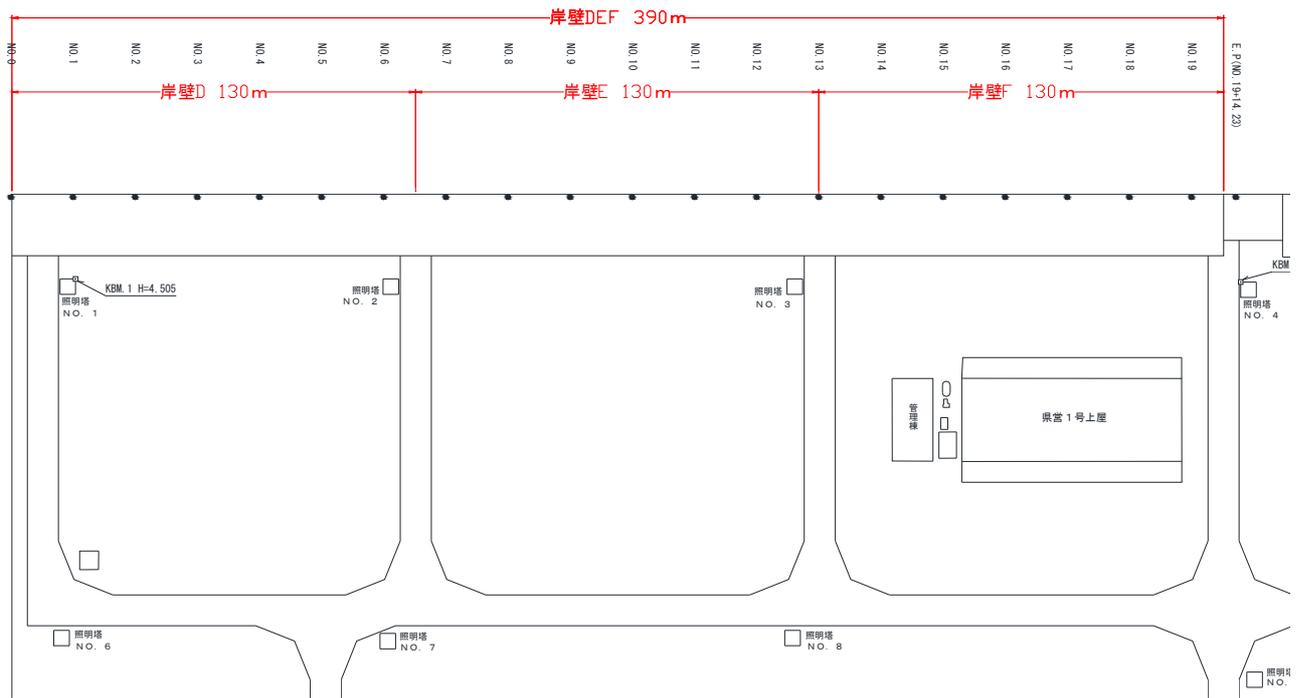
210 No.16 常陸那珂港区_北埠頭地区 D・E・F 岸壁 (-7.5m) の平面図 (被災前)
